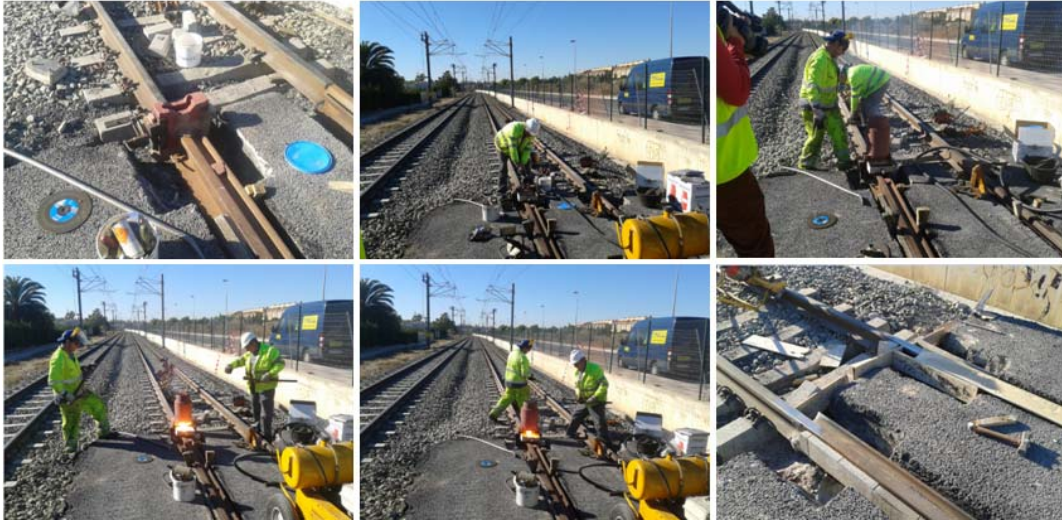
Soldadura aluminotérmica de la transición con la vía en balasto.
